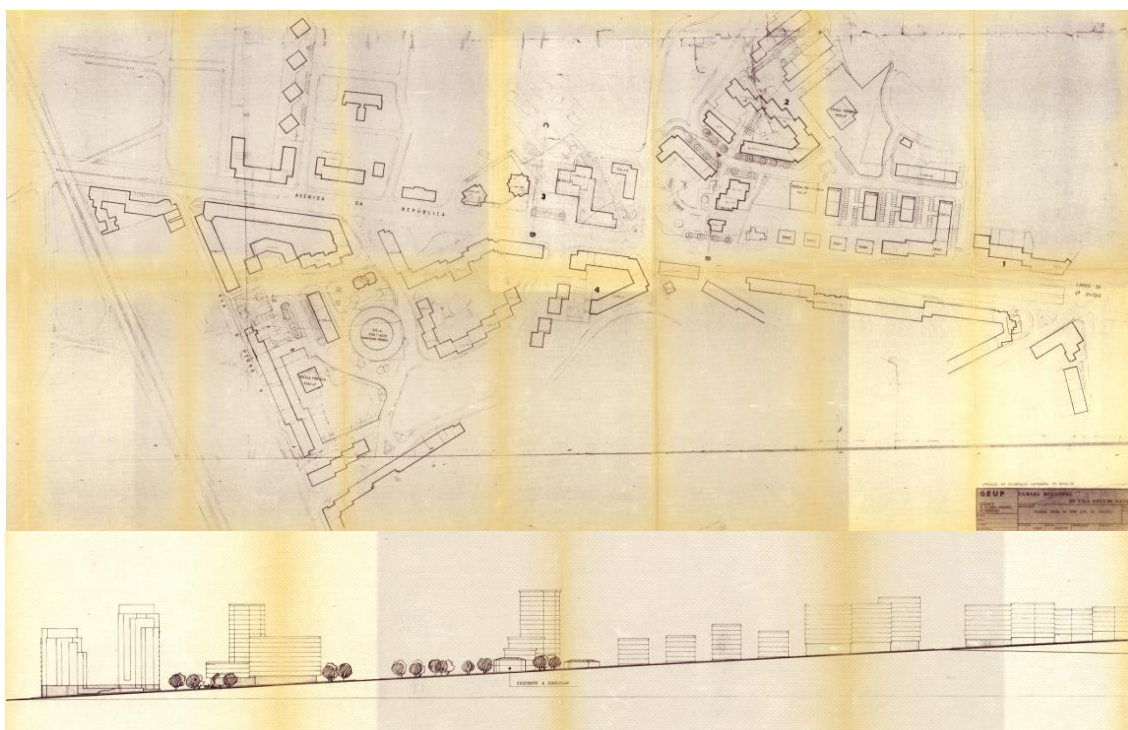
| Extrato da Planta Geral da Zona Alta da Avenida e perfil longitudinal, (1989)
